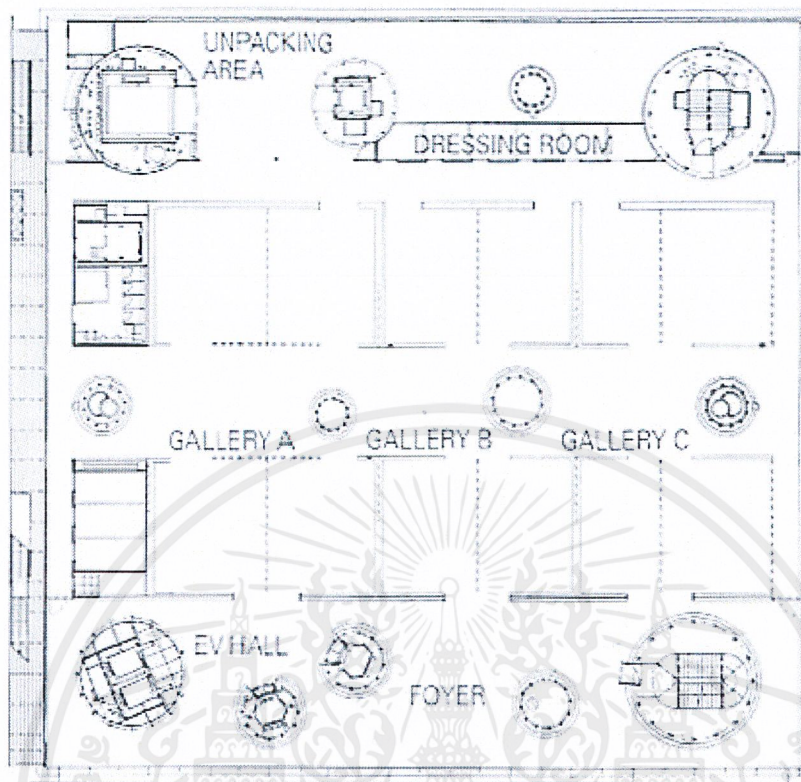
แสดงผังพื้นที่ 4 (4th Floor Plan)
